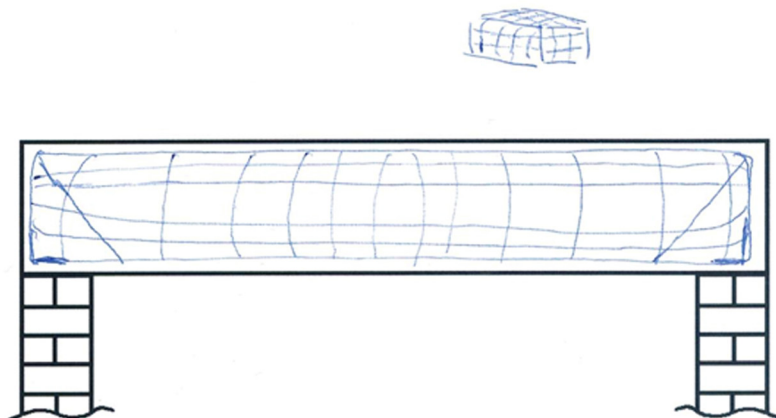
Schülerzeichnung 3 zur Lage der Bewehrung in einem Stahlbetonbalken (eigene Darstellung).
